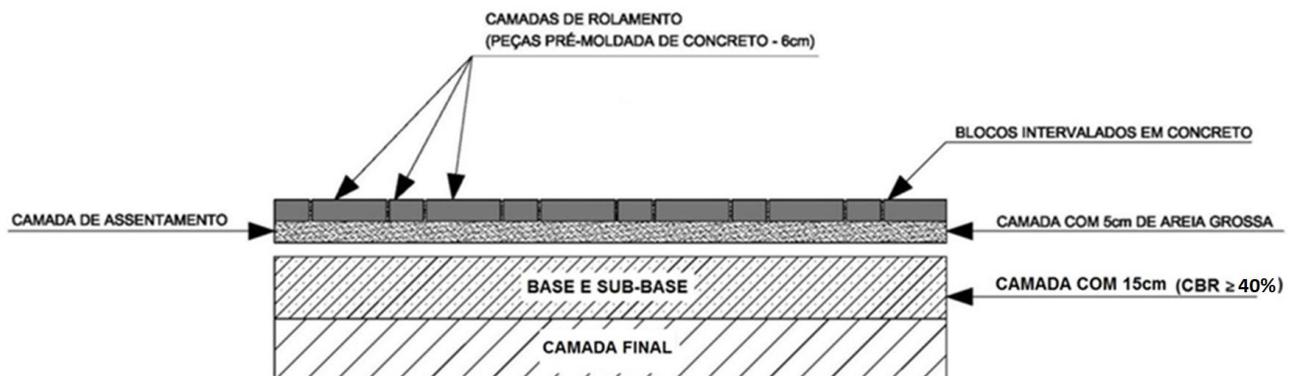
Estrutura do pavimento intertravado no estacionamento
